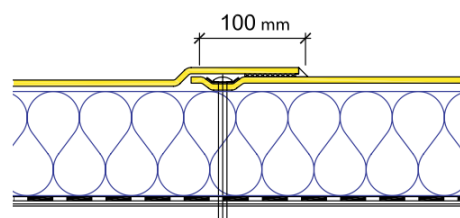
Fixação Mecânica e Sobreposição das membranas em estrutura de betão [Fonte: Renolit Waterproofing]
